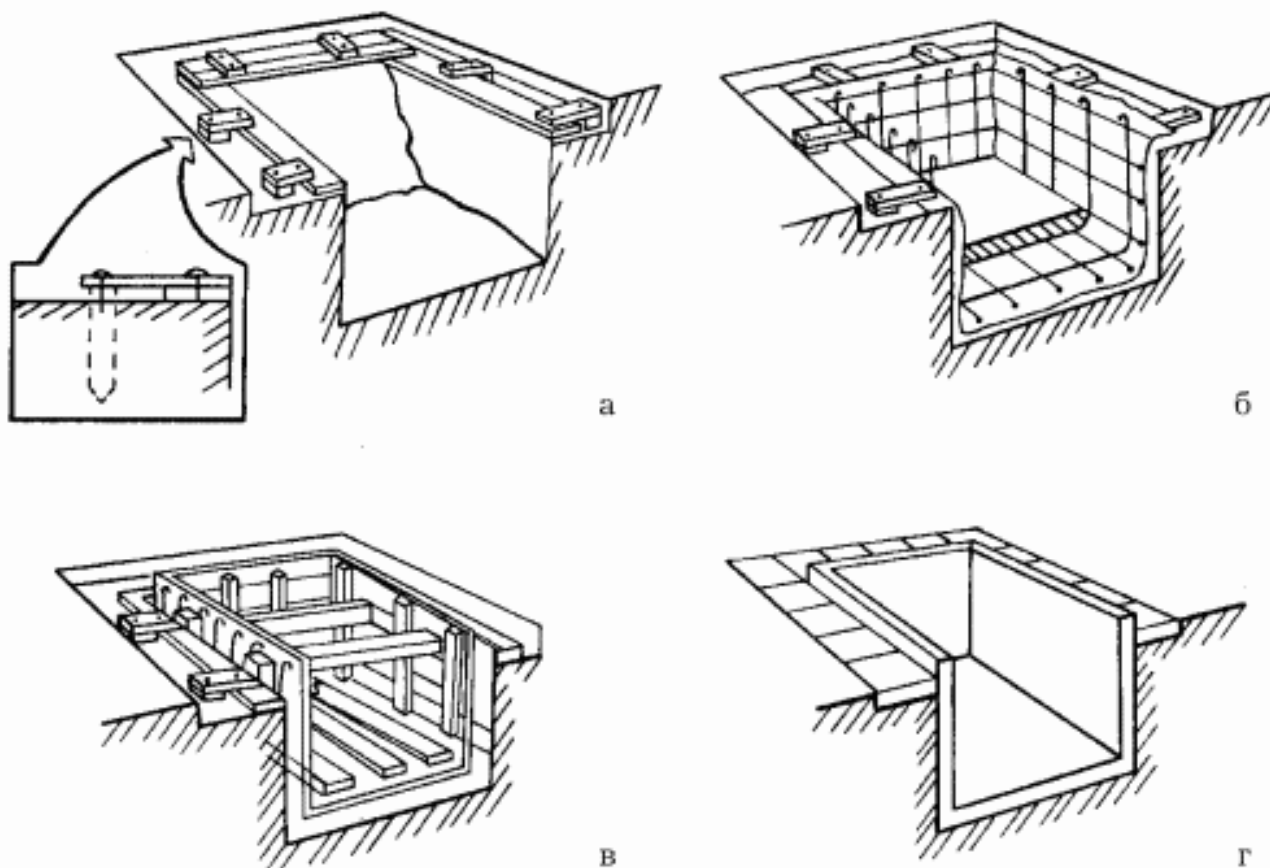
Бетонирование прямоугольного бассейна для купания: а – рытье котлована и установка досок контура; б – установка арматуры и бетонирование дна; в – установка опалубки и бетонирование стенок; г – отмостка вокруг бассейна.
